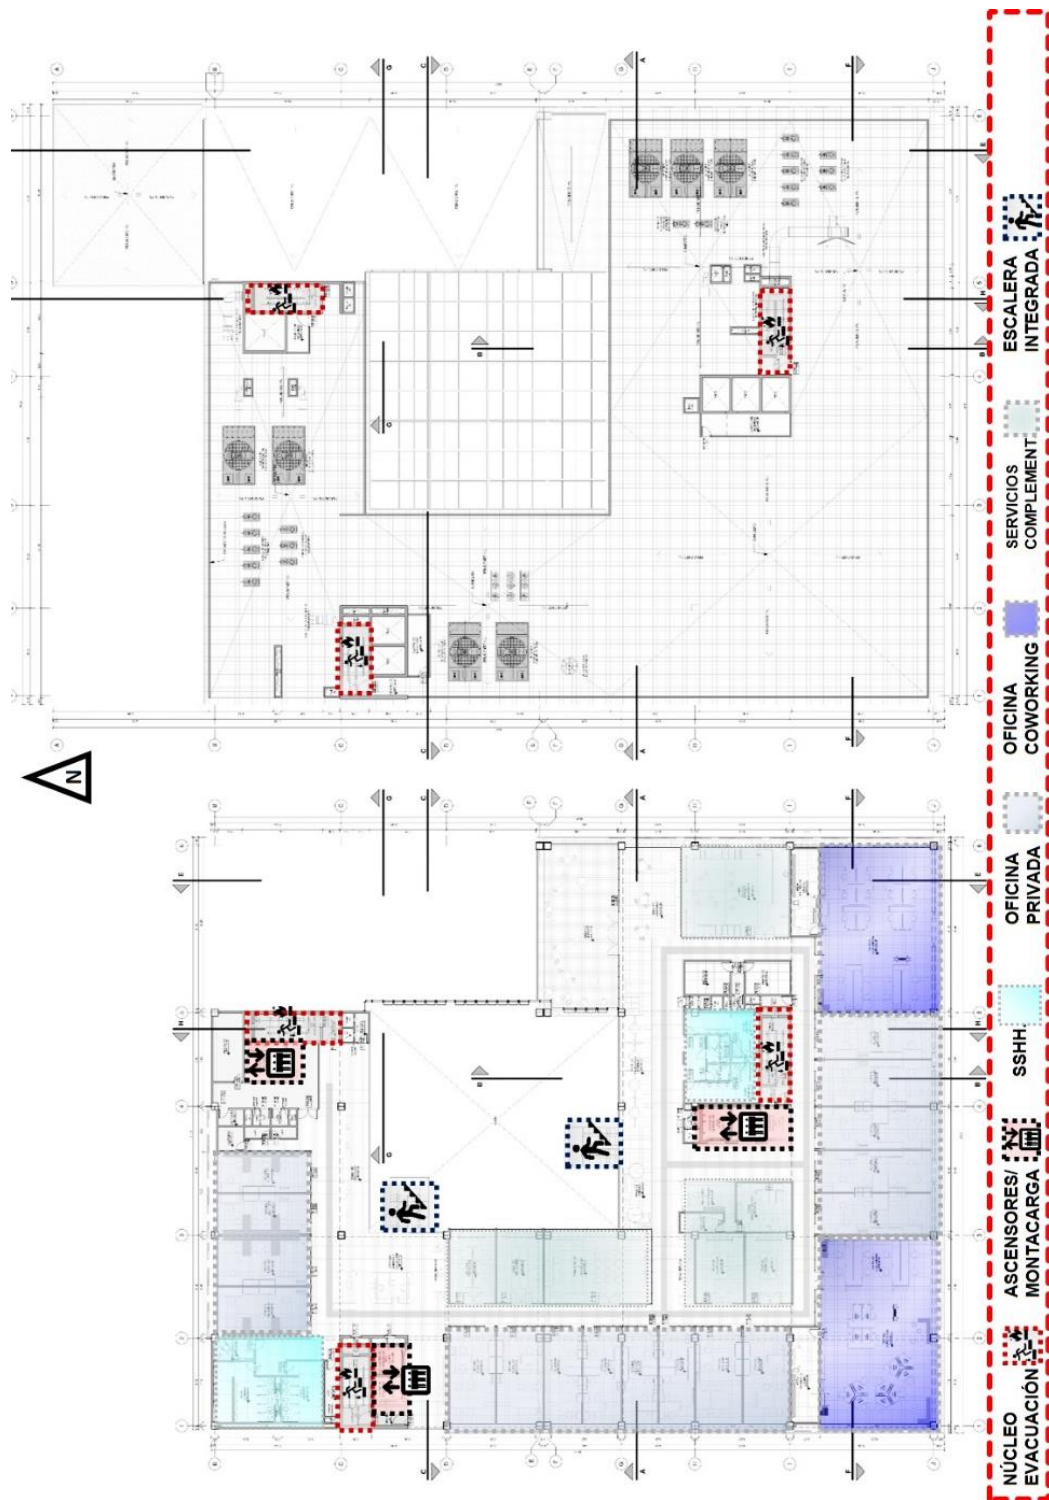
Vistas de las plantas generales del octavo piso (inferior) y de la planta techo (superior).
